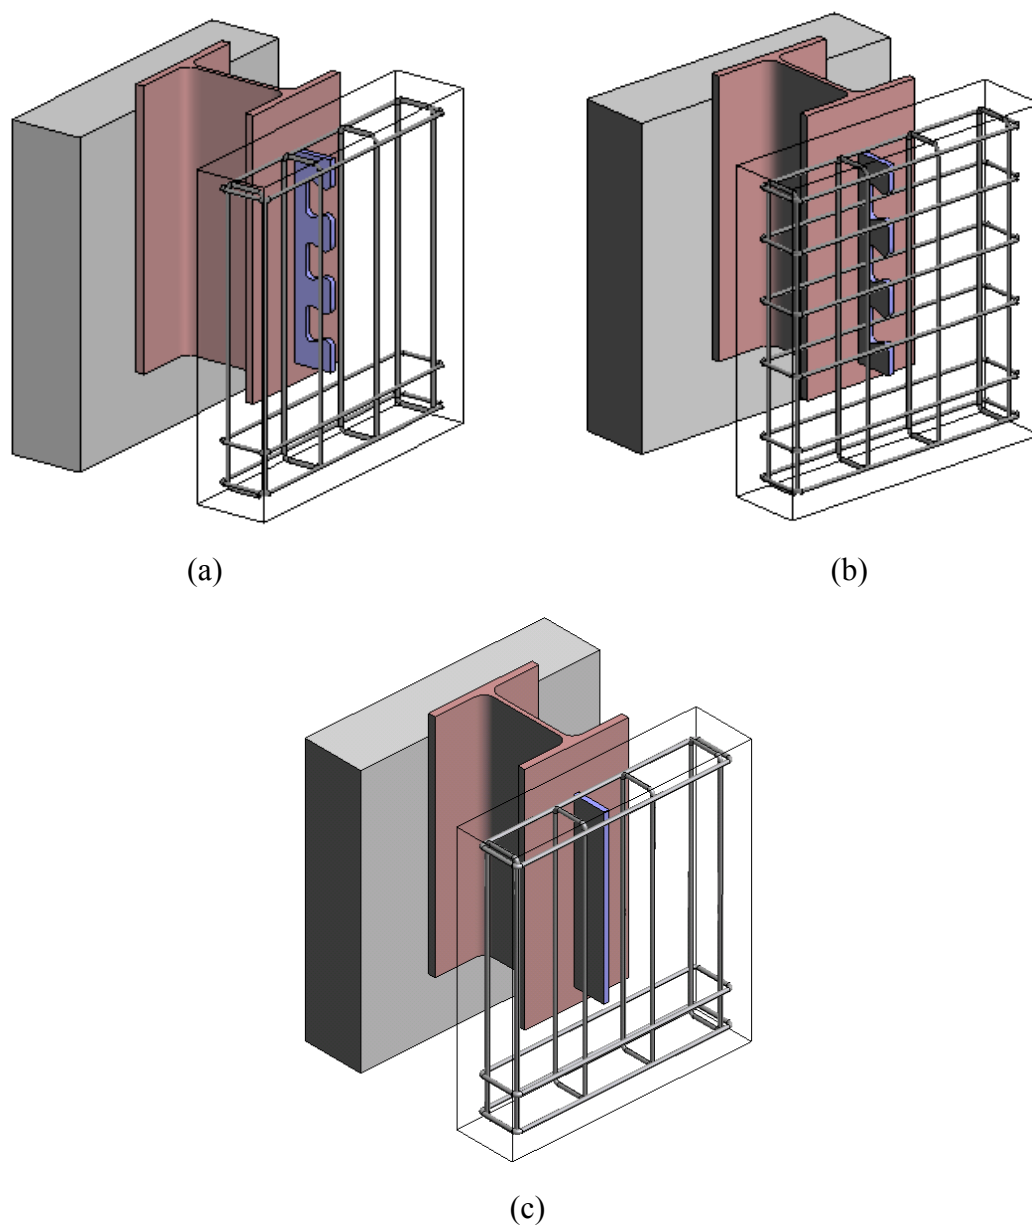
Configurações dos modelos com CR56b: a) sem armadura passante; b) com armadura passante; c) conector sem dentes.
